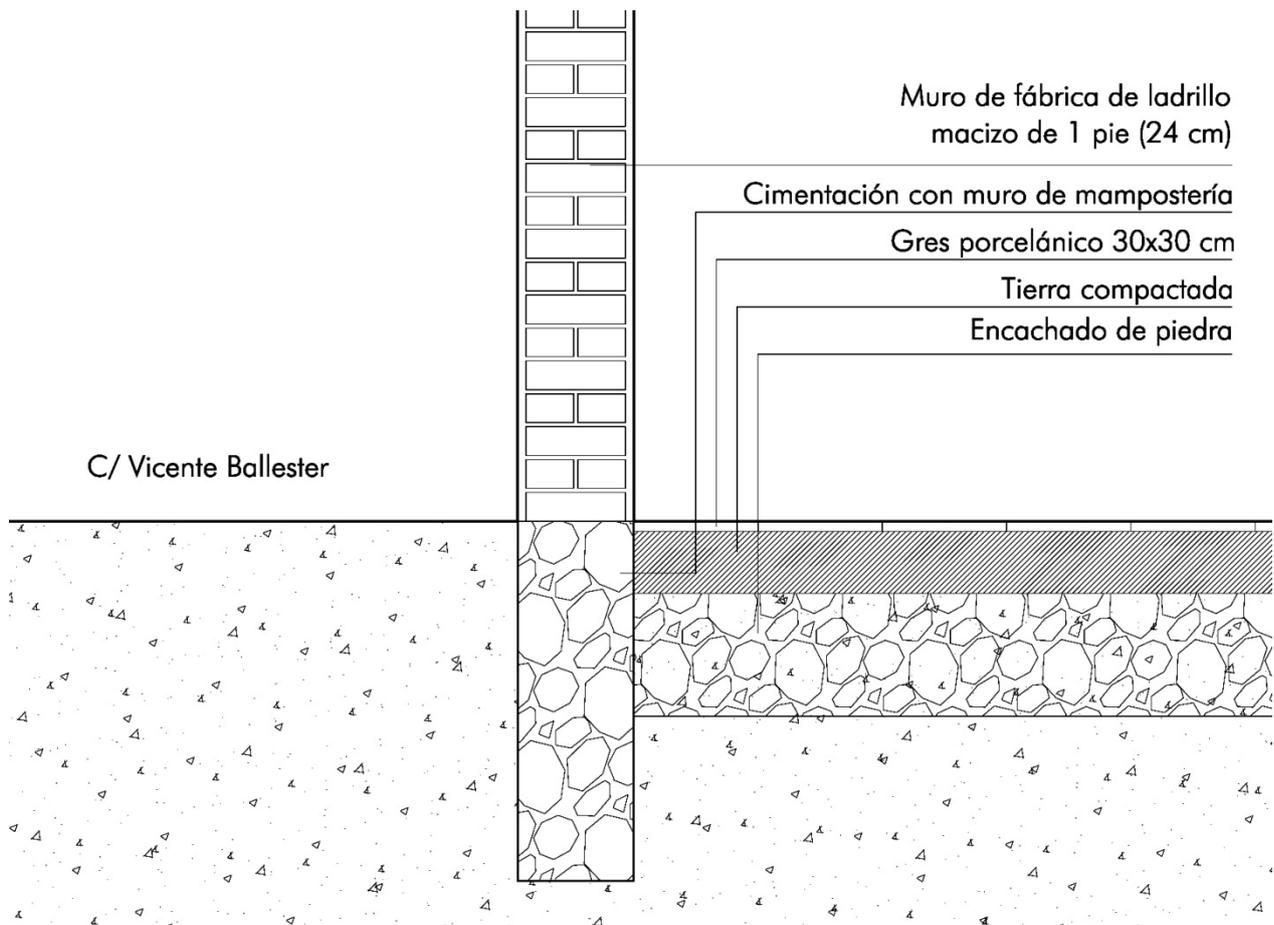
Detalle cimentación fachada principal. Fuente propia. Anexo II plano nº 6
